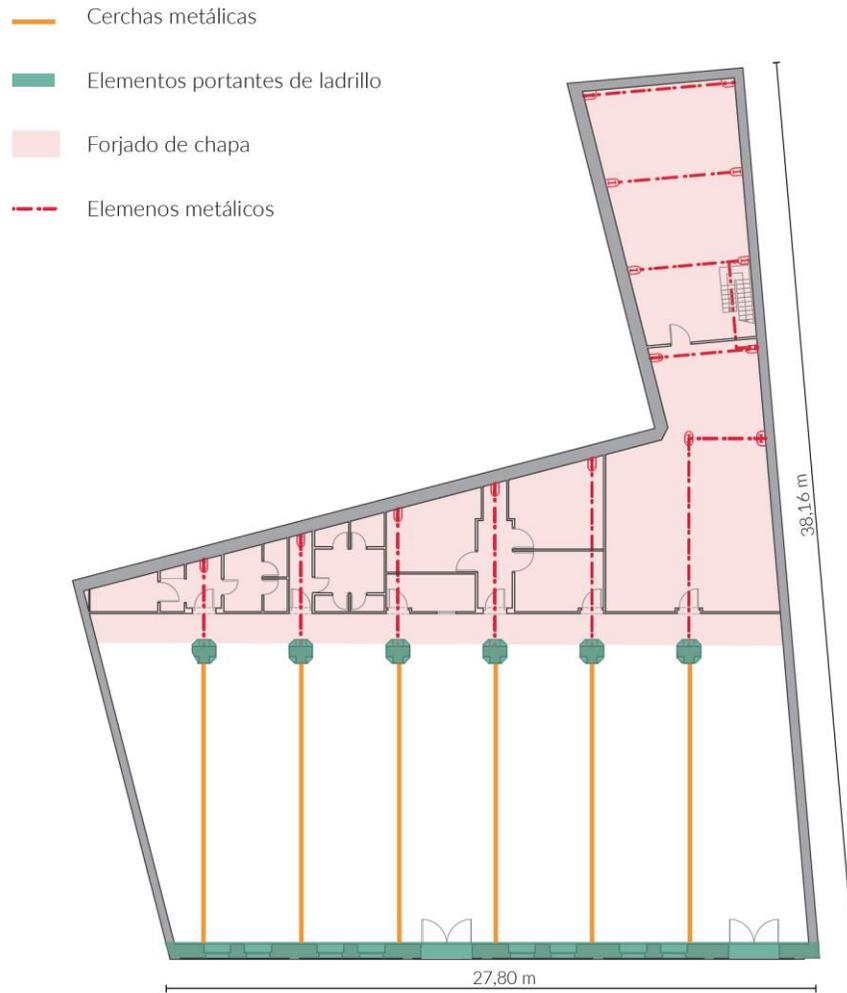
Planta de estructura esquemática del cielo, Elaboración propia.
